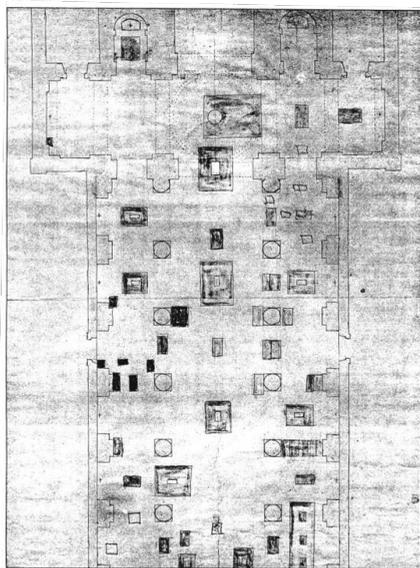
Pianta della chiesa (inizio sec. XIX) con indicazione delle sepolture.
